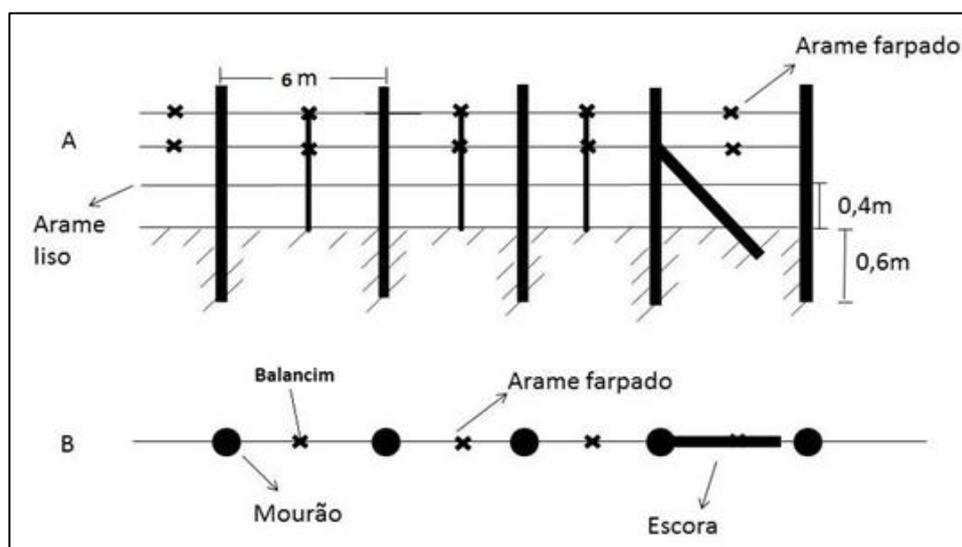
Croqui de cerca tipo leve (A – vista frontal e B – vista superior).
